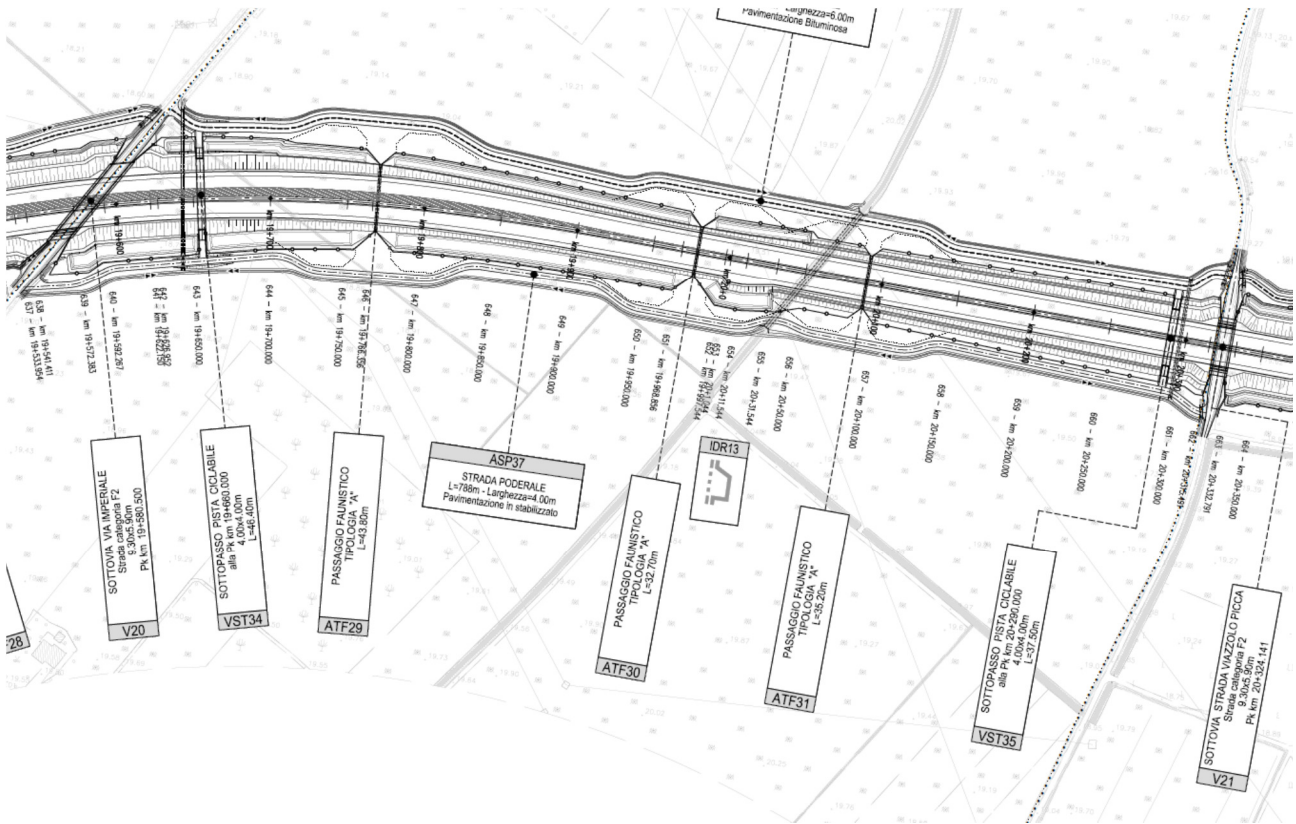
STRALCIO PLANIMETRICO
